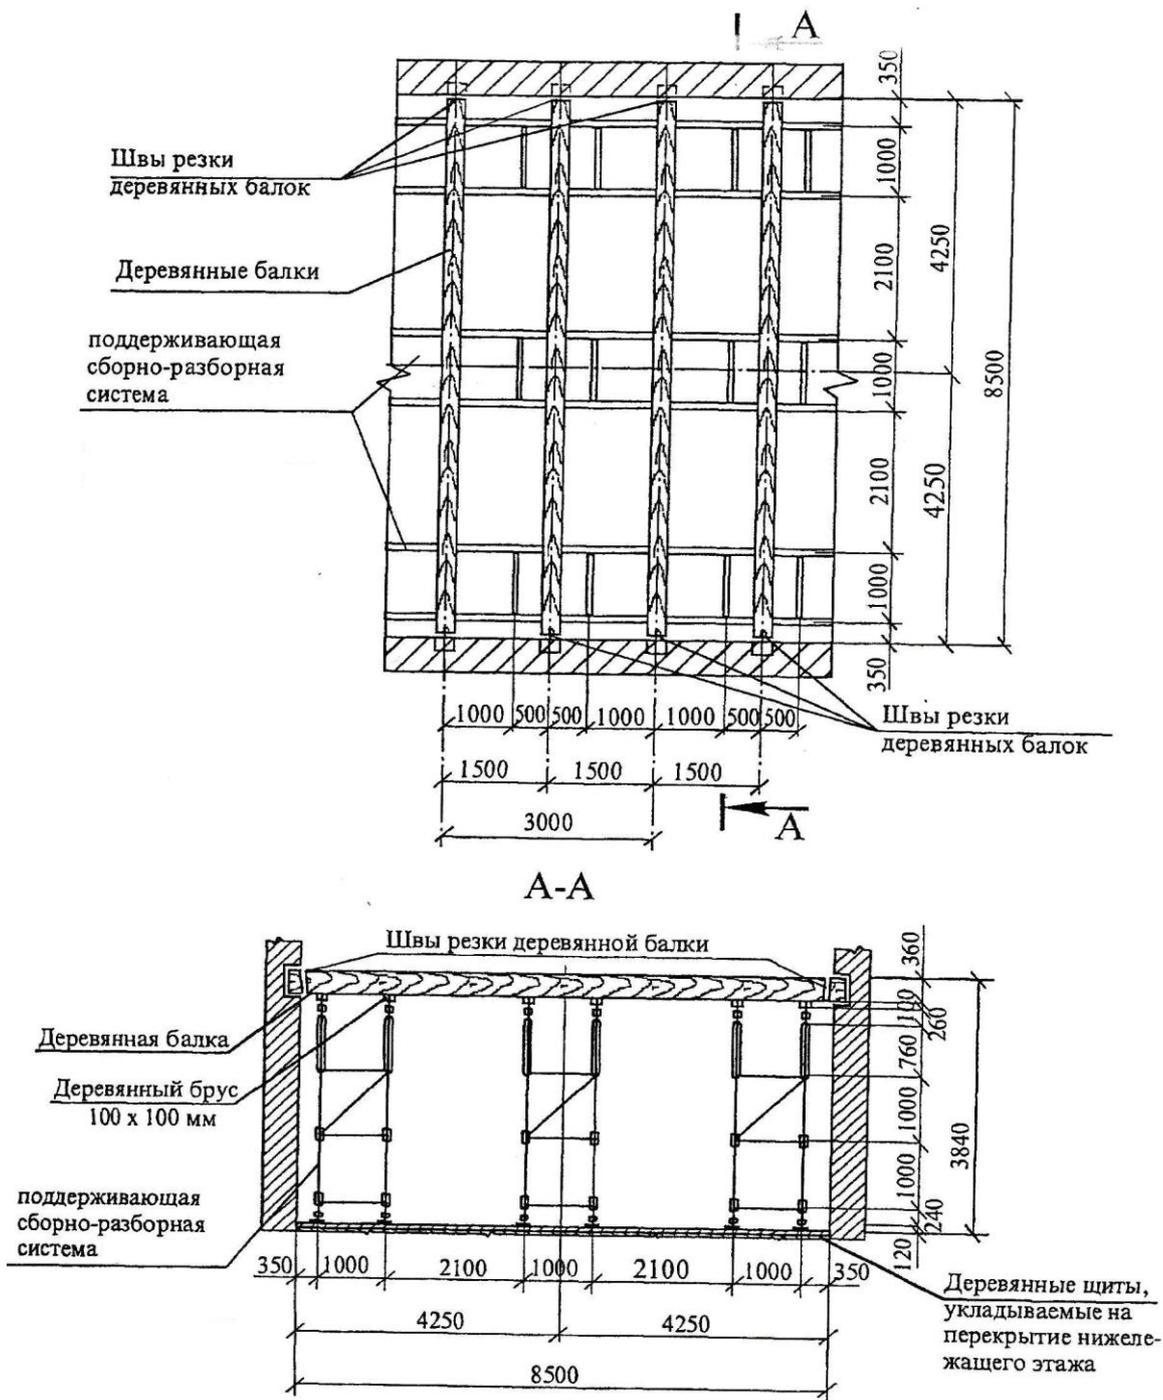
Схема разборки междуэтажного перекрытия по деревянным балкам
